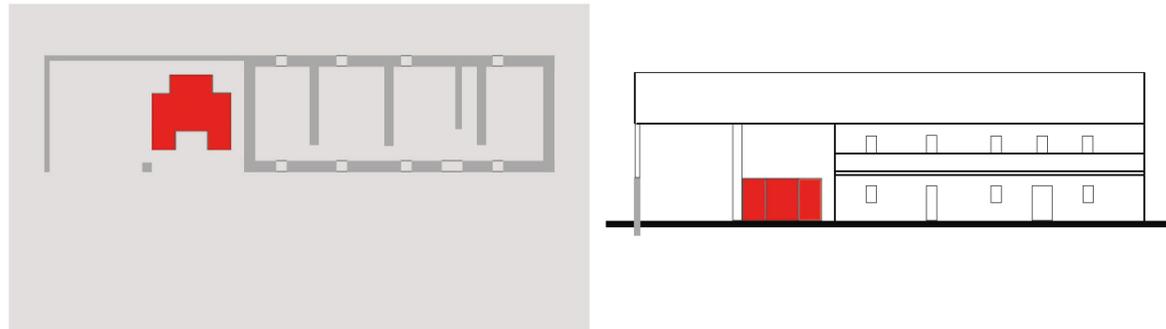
Schemi di collocazione in pianta e in prospetto del Modulo Abitativo MAACC all'interno dei edifici con destinazione d'uso residenziale, fonte: elaborazione immagine dell'autore
